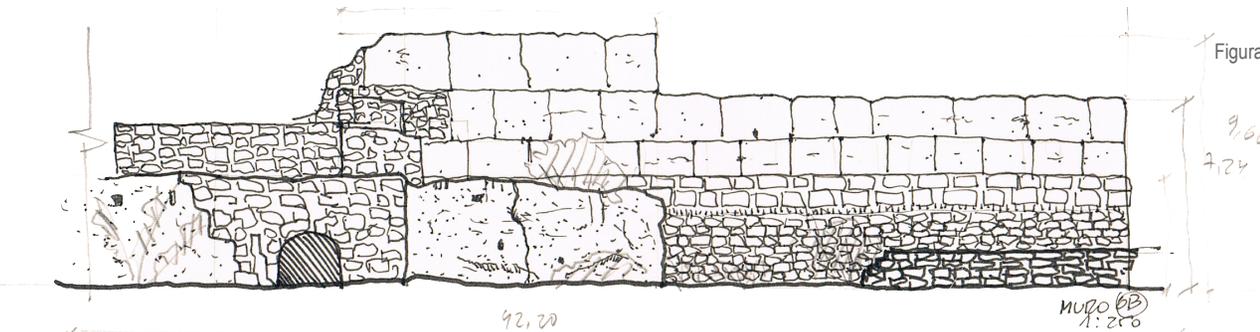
Levantamiento preliminar de la Mina Constanza.
